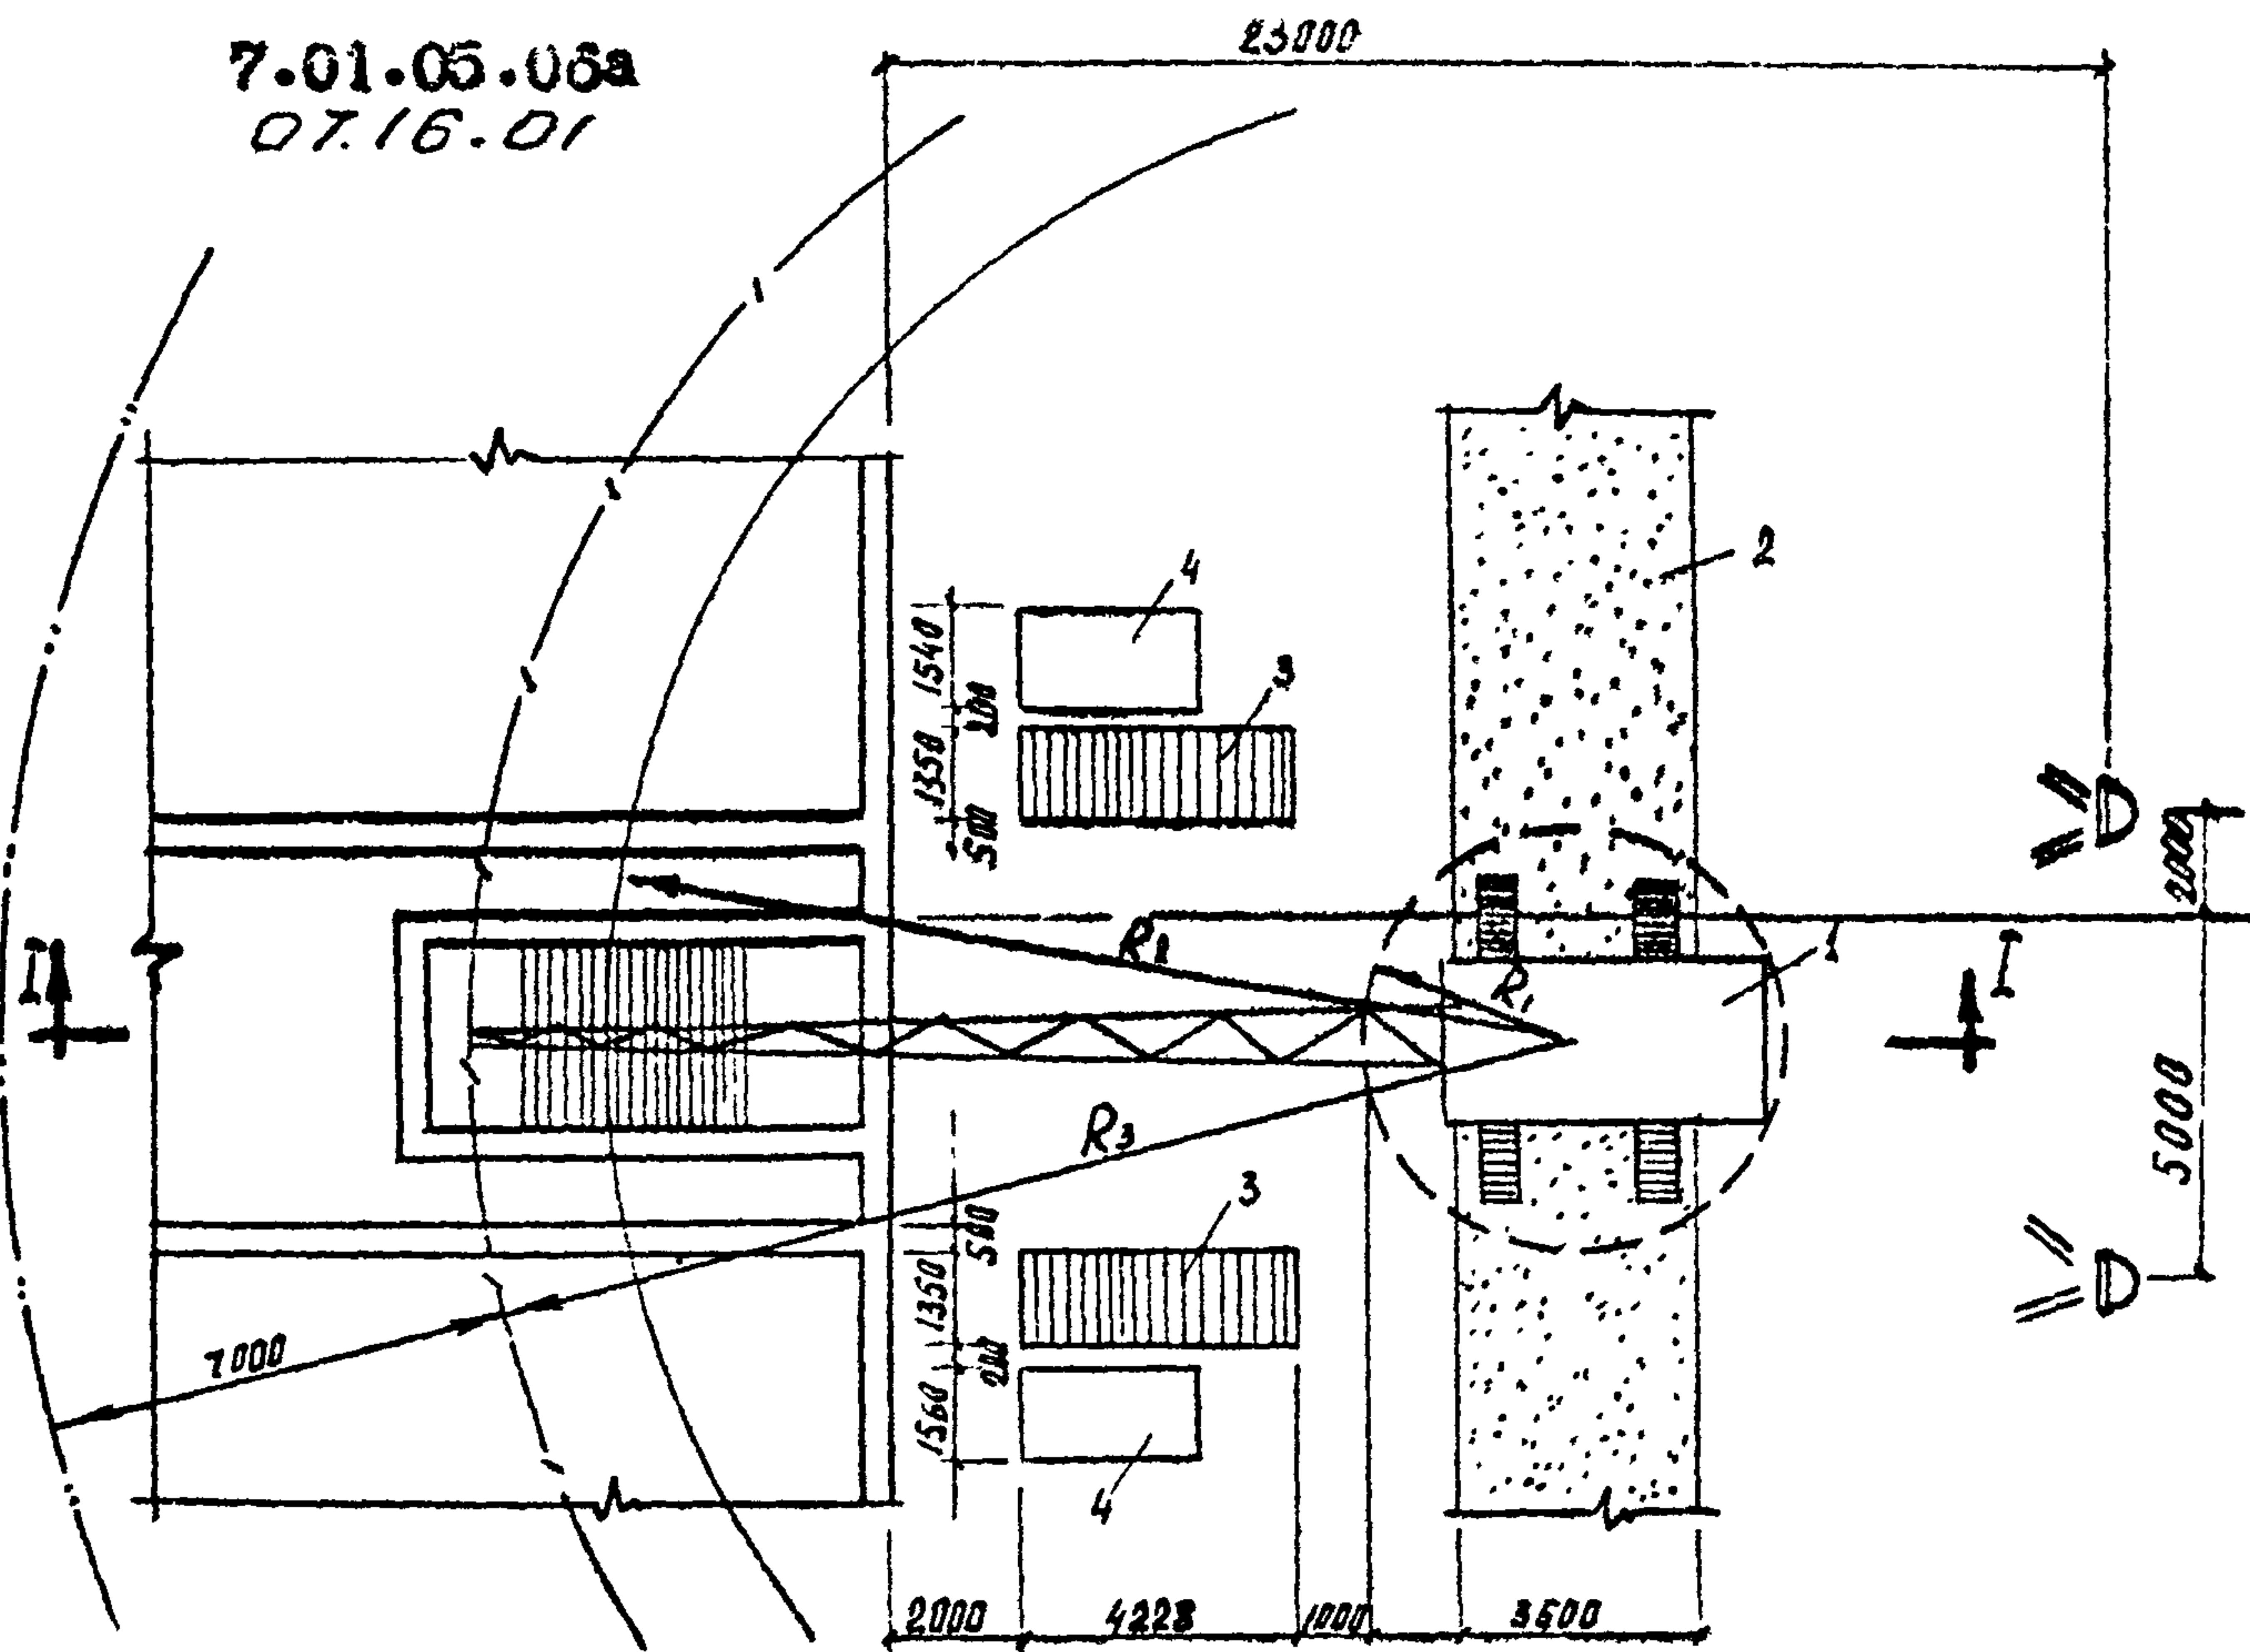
Схема складирования и монтажа лестничных маршей и площадок гусеничным краном.
